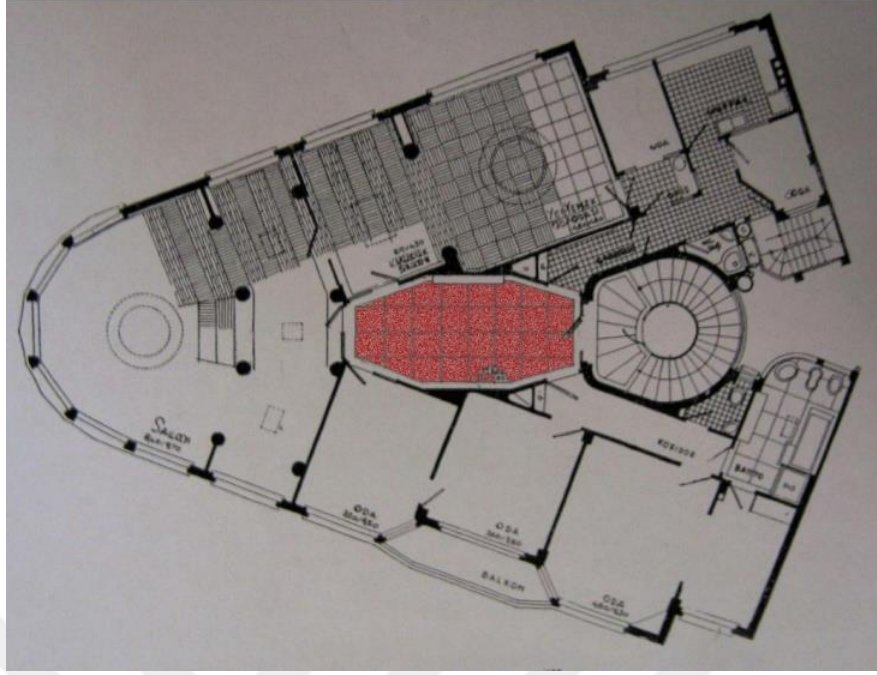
Ressam Şevket Bey Yalısı Birinci Kat Planı (Sofalı Ev Planı)
